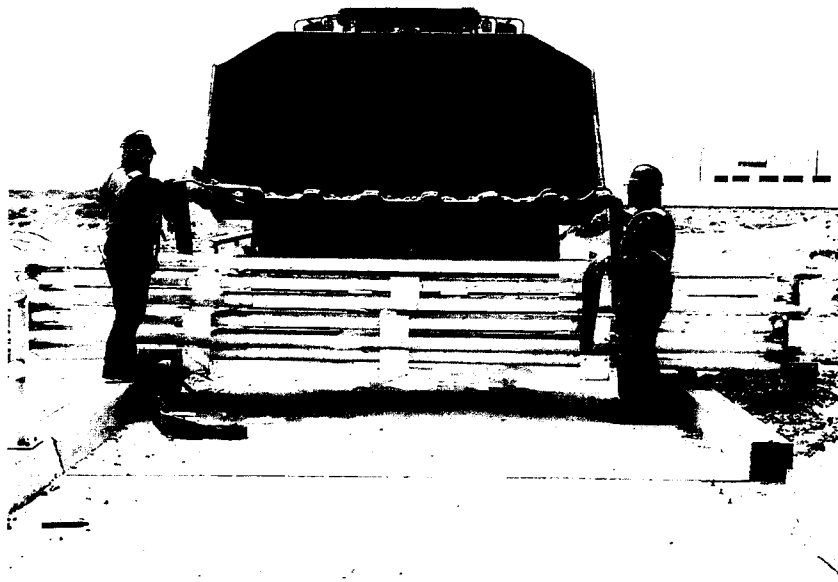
Traslado de barandas para su instalación en el muelle San José
